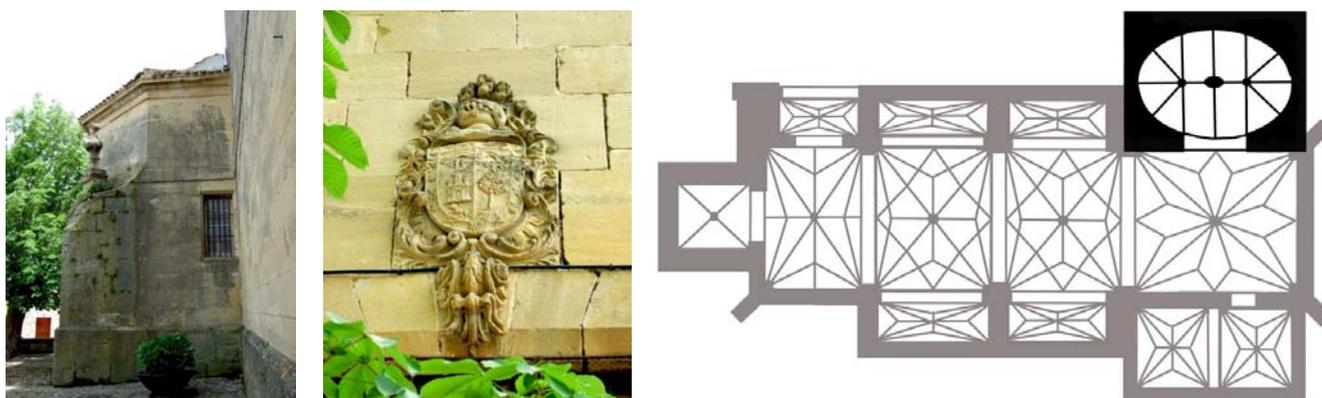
Planta original y detalle del alzado exterior de Capilla de la Virgen de Guadalupe en la iglesia parroquial de Castañares de Rioja, levantada a expensas de Manuel Silvestre Pérez de Camino entre 1753 y 1757.
